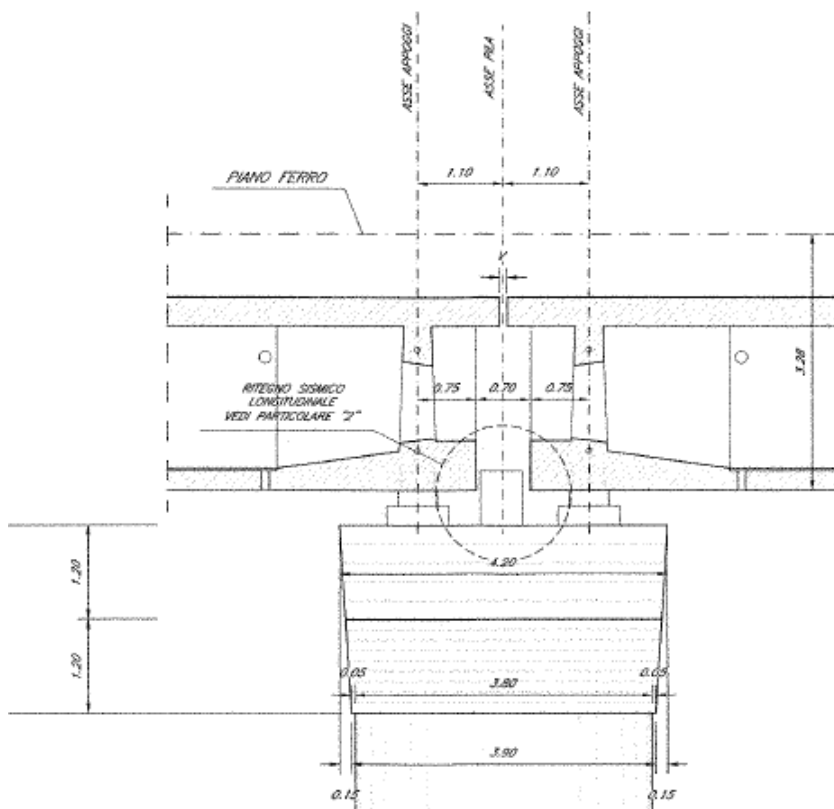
Pila, prospetto longitudinale – Due impalcati CAP
